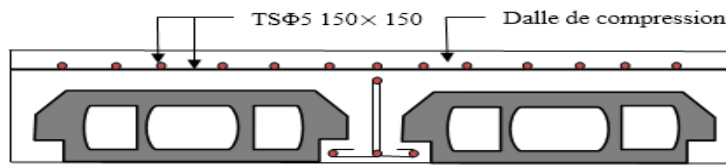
Schéma de ferrailage de la dalle de compression
